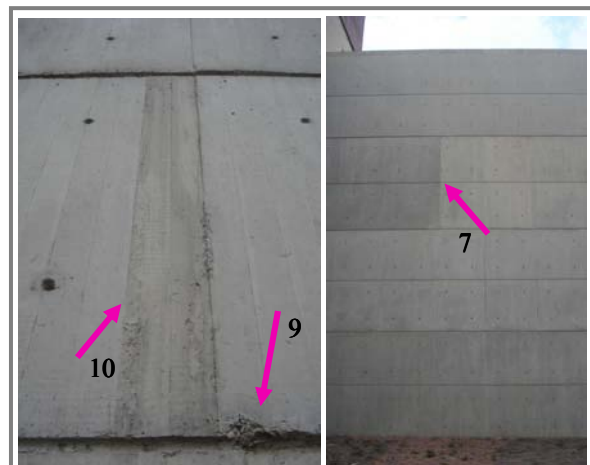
Defecto 9 rebaba, defecto 10 desalineamientos y 7 líneas entre capas.
